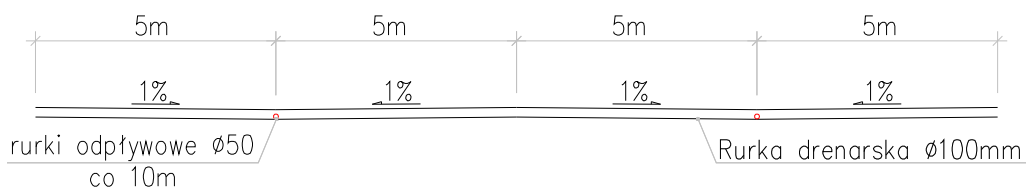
Szczegół wykonania montażu rury odprowadzającej
